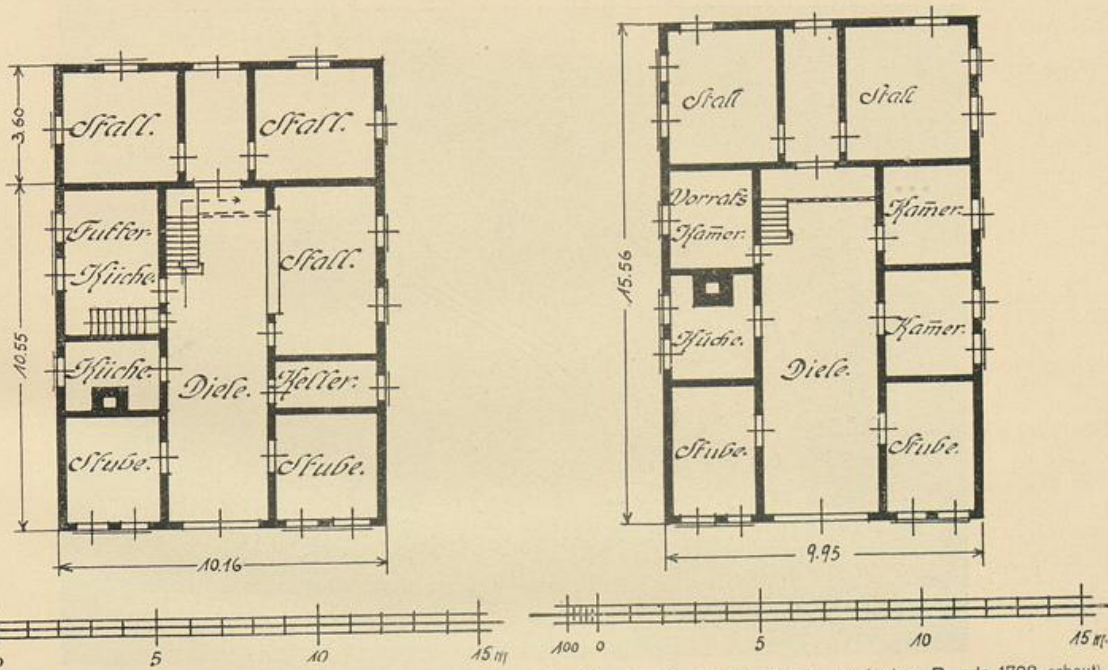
Lügde, untere Straße (vor dem Brande 1796 erbaut).
